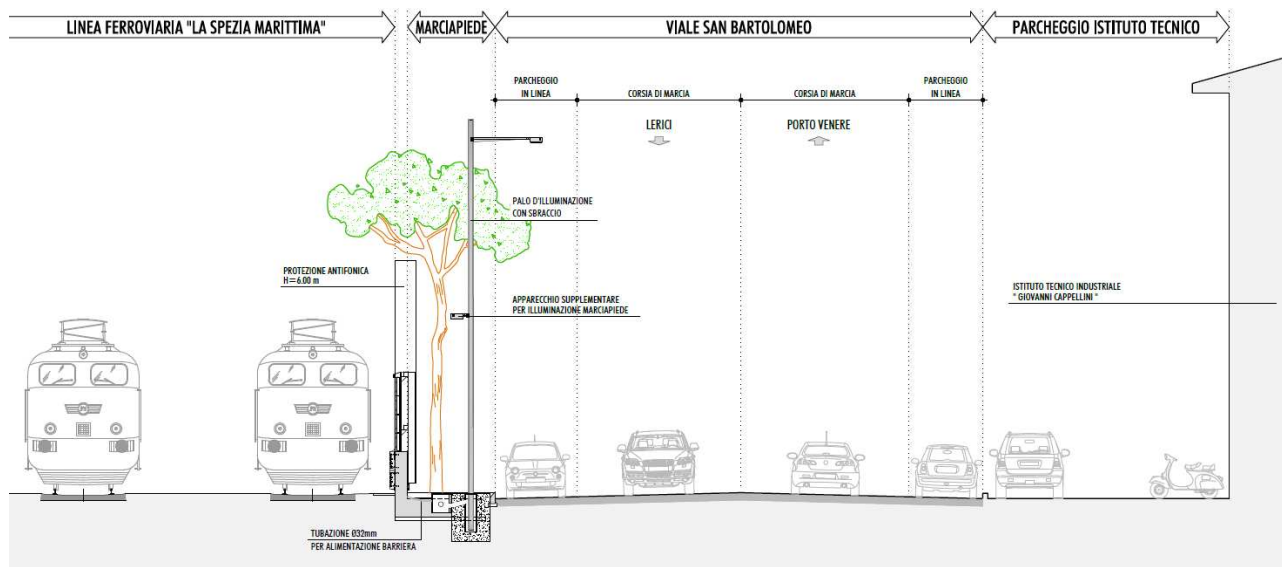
SEZIONE TIPO LUNGO VIALE S.BARTOLOMEO – NUOVA ILLUMINAZIONE
